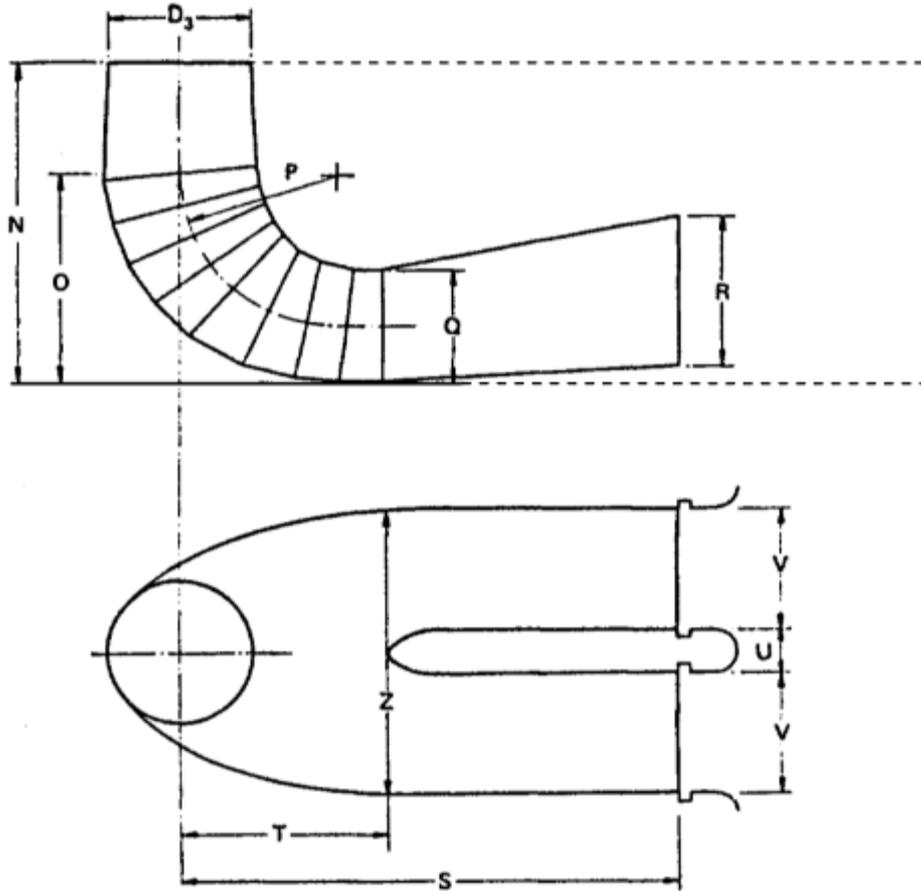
Alzado y planta del dimensionamiento del tubo de aspiración.
